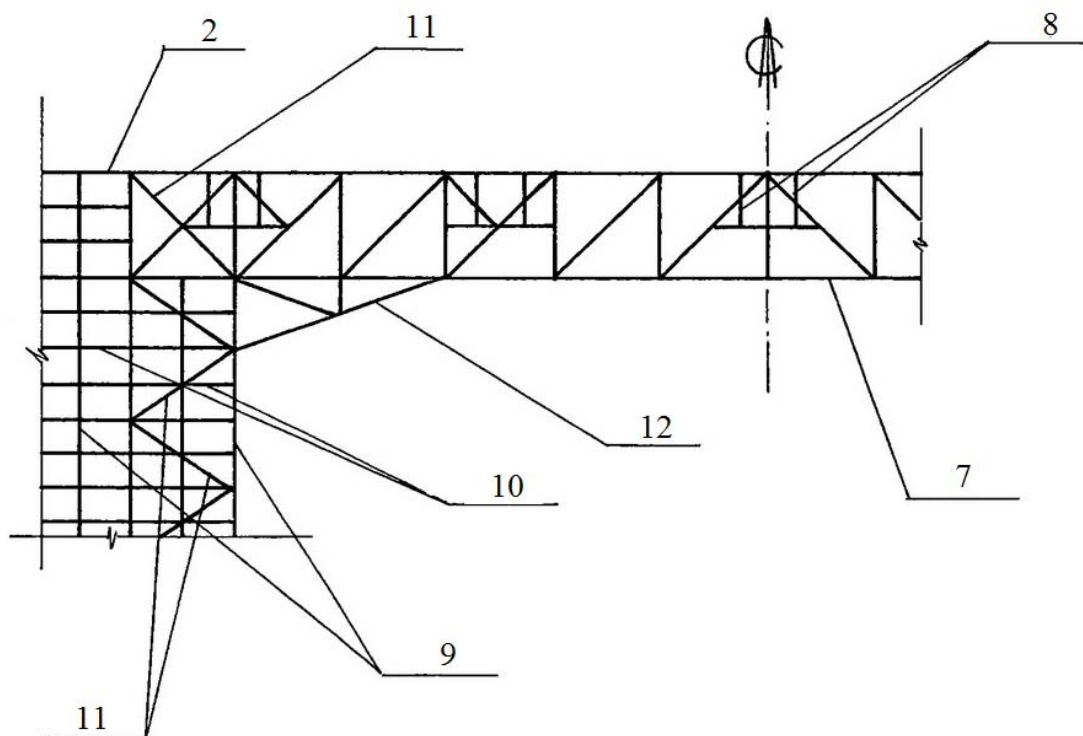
Сопряжение основной продольной несущей конструкции покрытия с каркасом угловых зданий
